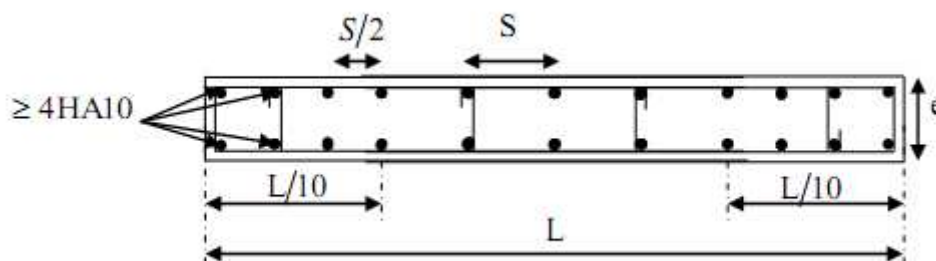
Disposition des armatures verticales dans les voiles.
